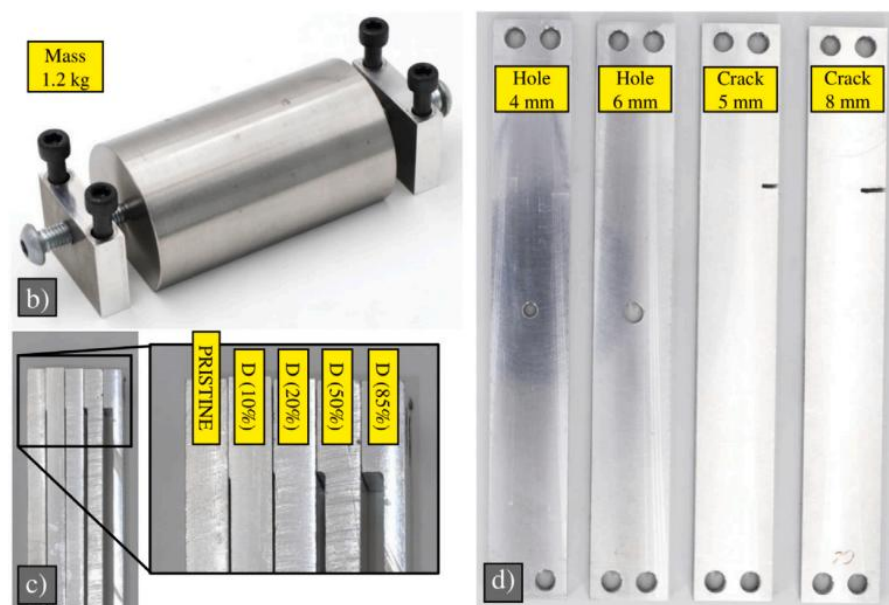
Tipos de danos aplicados à estrutura no estudo de Font-Moré et al. (2023) [16], incluindo adição de massa, furos, fissuras e reduções da seção transversal das vigas
